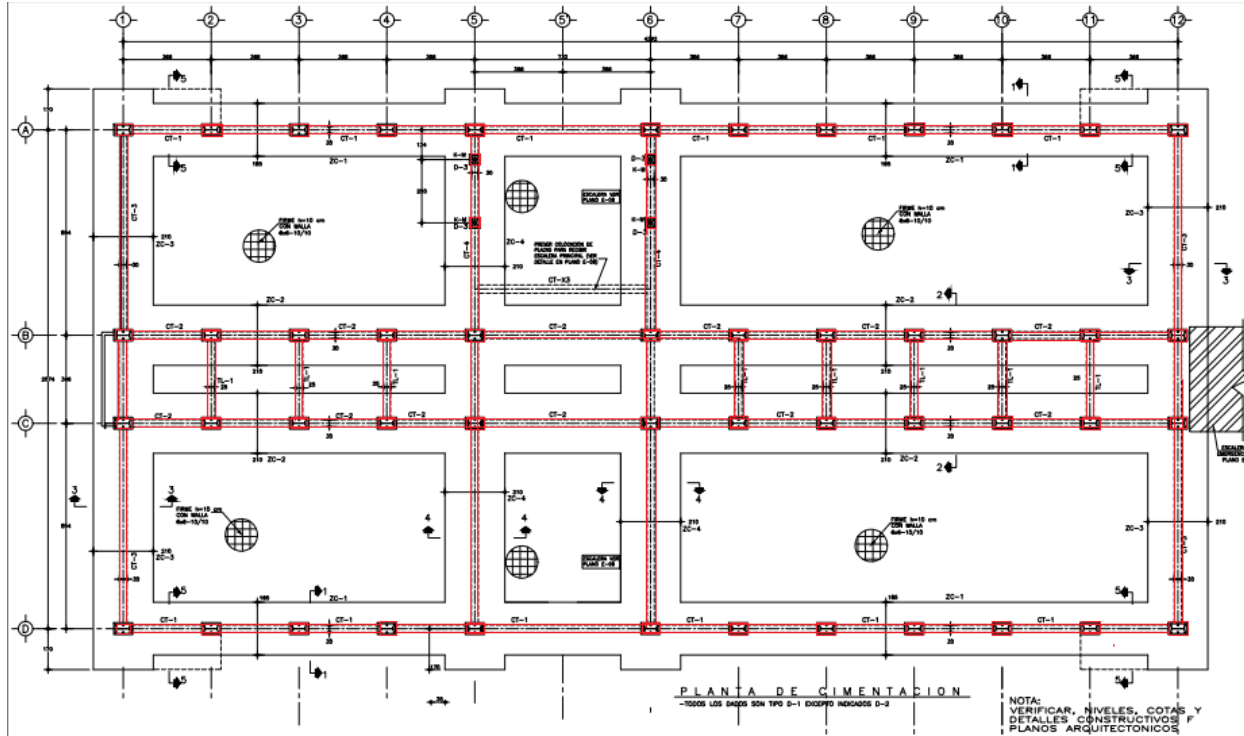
Vista en planta de la distribución de zapatas y dalas de cimentación del edificio
